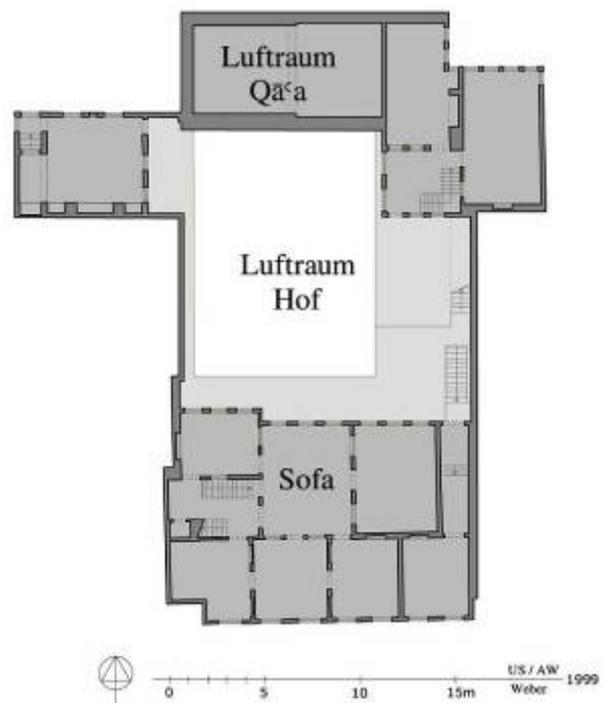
Bayt Zanānīrī, Grundriss OG
